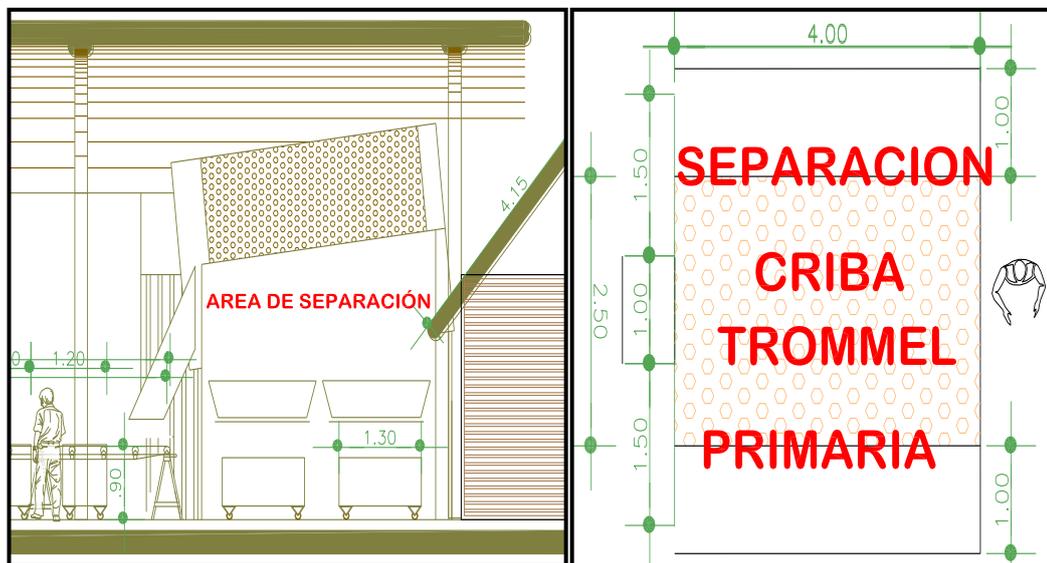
Vista arquitectónica de la criba trommel en la separación primaria
